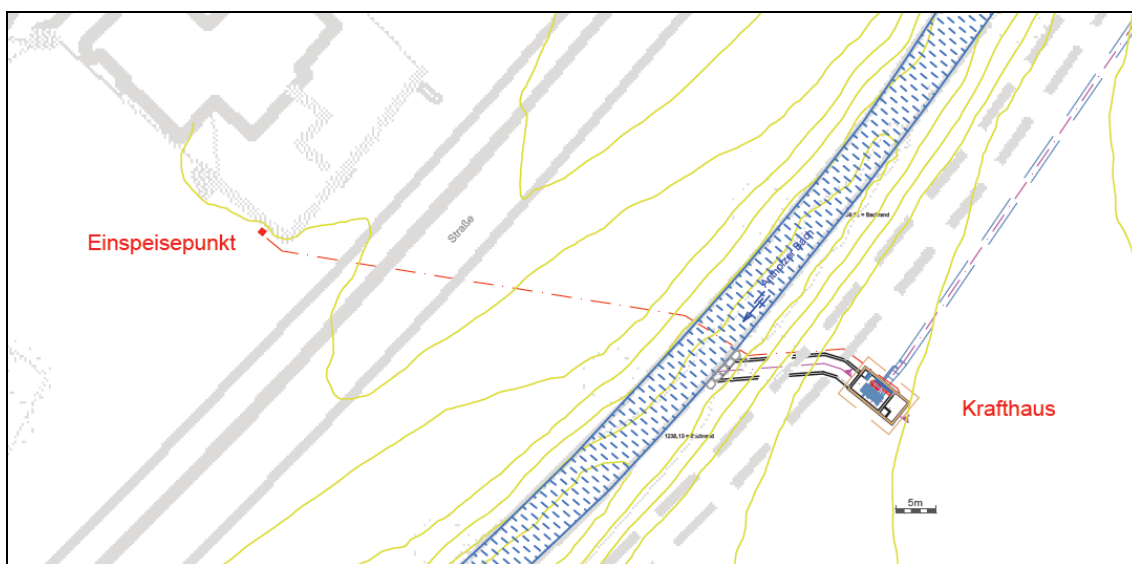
Planimetria di progetto: centrale e restituzione (fonte: Tavole progettuali)
